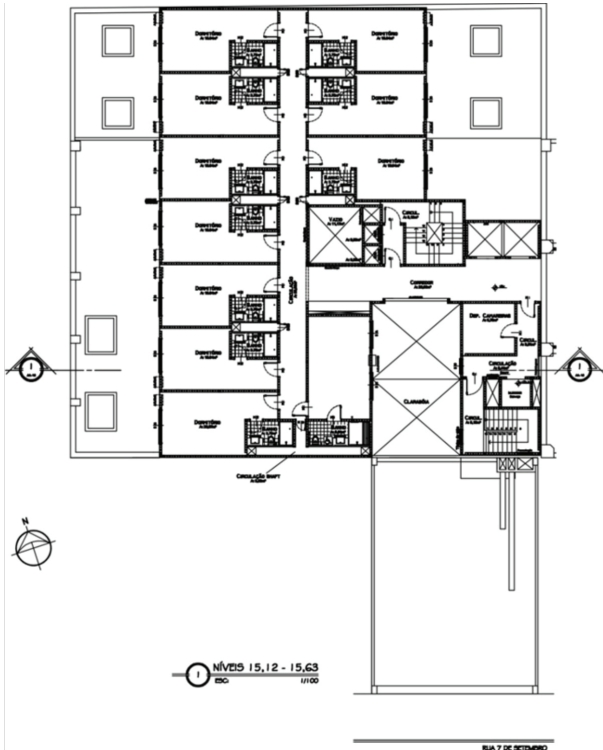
Planta baixa do pavimento tipo, Hotel Jacques George Tower, Vega Amaral.
